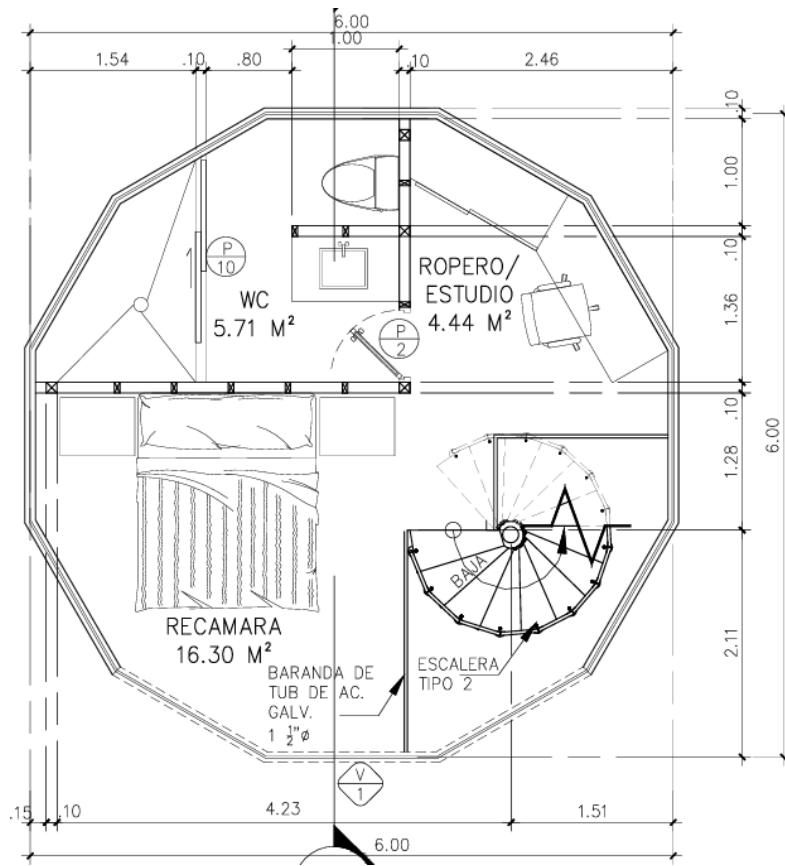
Vista en planta de segundo nivel de dormitorio de 6 m de diámetro.
